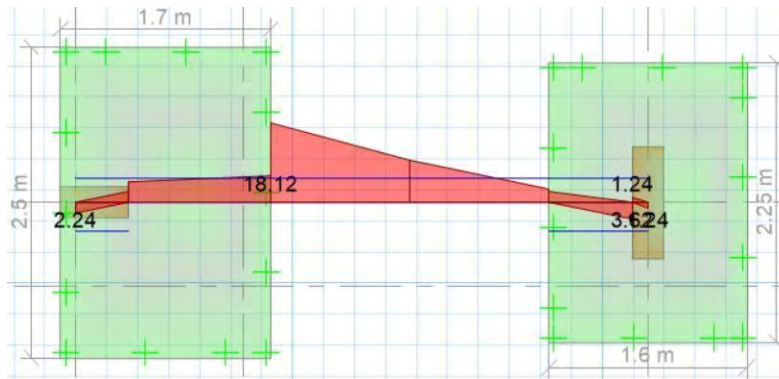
Viga VC-03 – Acero requerido (cm²)
